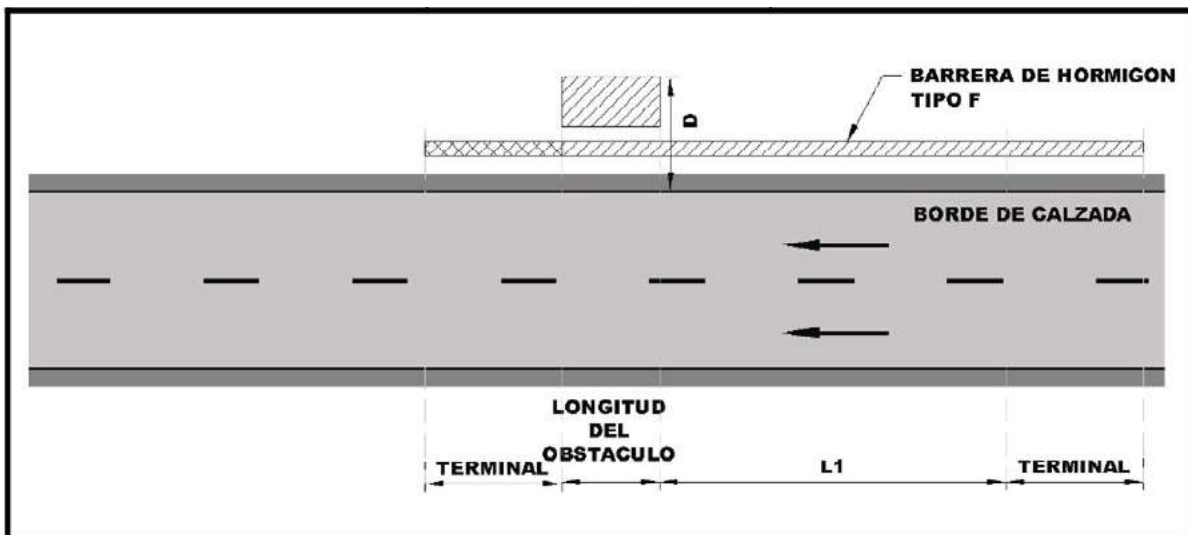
57. DISPOSICION DE BARRERAS DE HORMIGON EN OBSTACULOS LATERALES (CALZADA UNIDIRECCIONAL)
